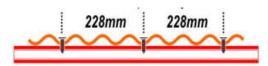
Unión plancha-purlins. Tomada del Manual Practico Sistema de cubiertas Metálicas.
